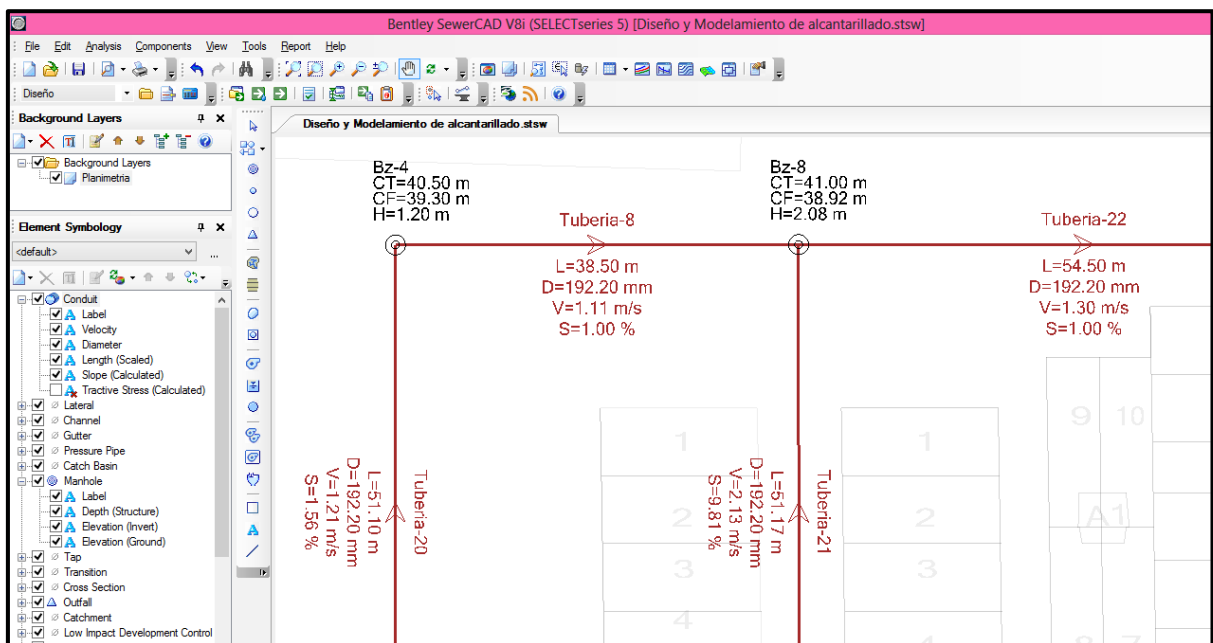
Colocacion de caudales para el diseño de alcantarillado
